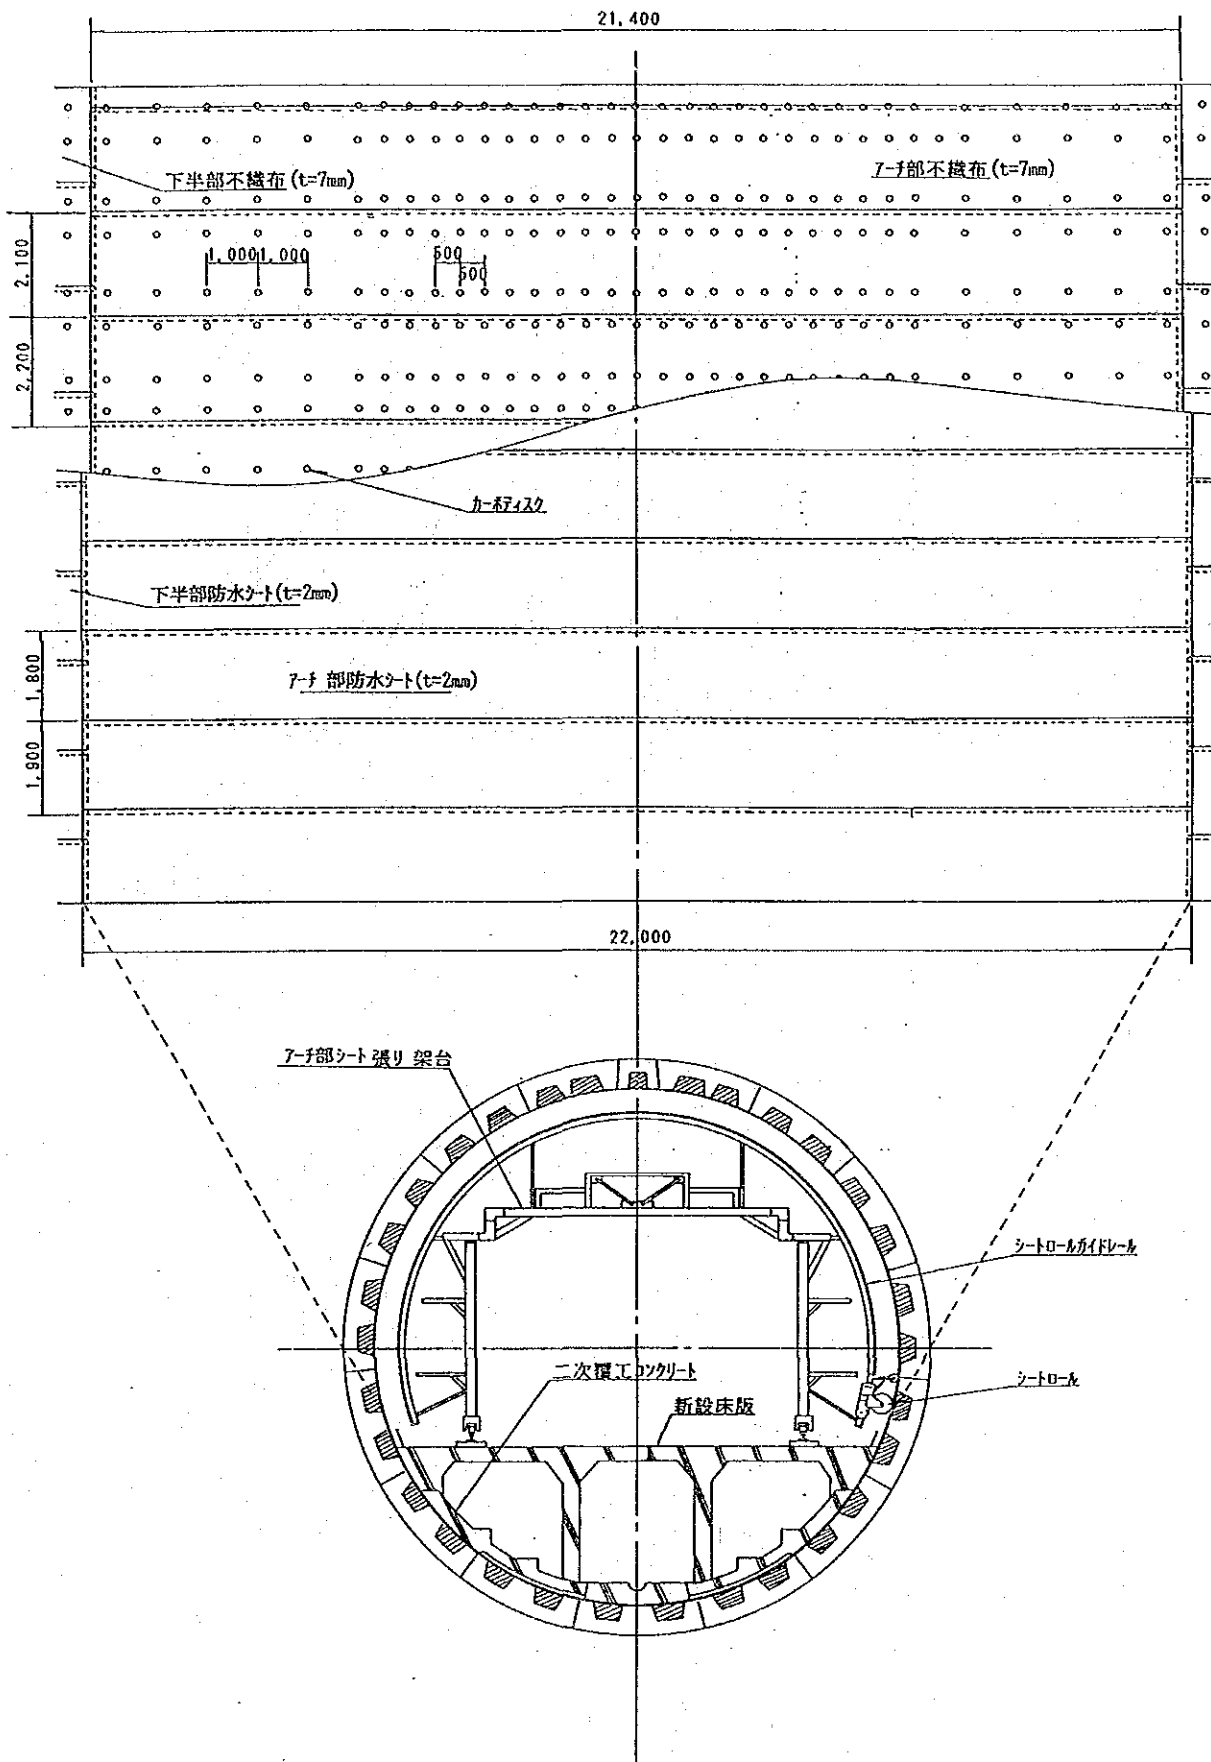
(3)-7 防水シート展開図 (上部アーチ施工時)
